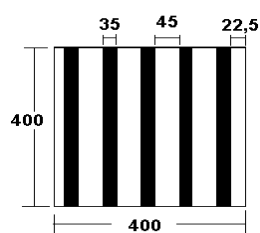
Planta do piso tátil direcional (ACAPO (s.d.))
